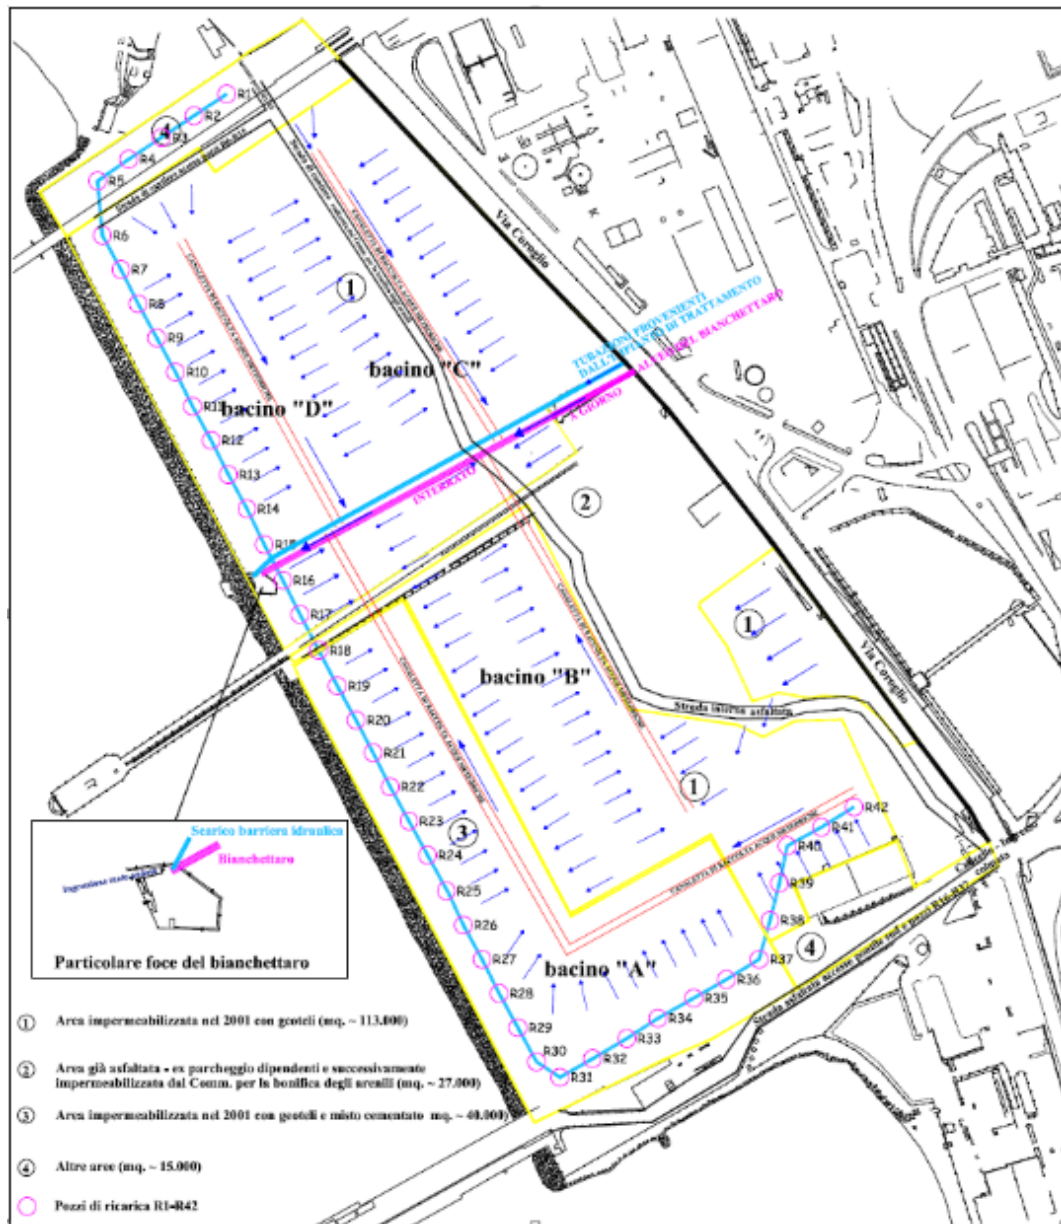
Planimetria impermeabilizzazioni, pozzi di ricarica e scarico TAF in colmata
